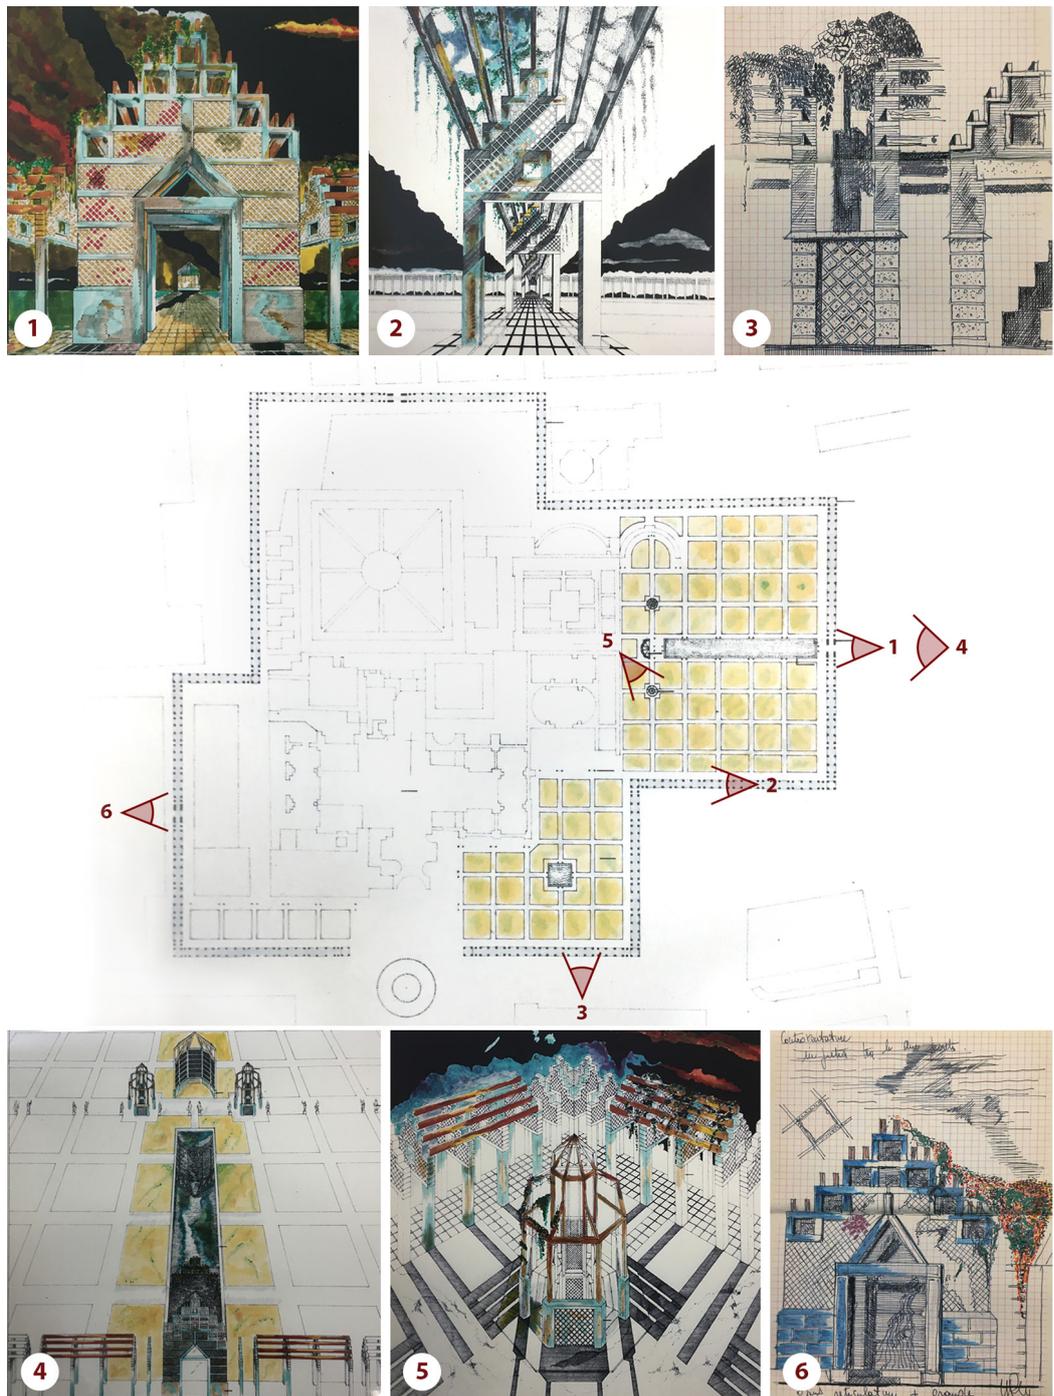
Collocazione dei punti di vista delle prospettive disegnate da Introini sulla planimetria delle terme di Diocleziano. (Disegno degli autori, servizi Bibliotecari e Archivi, Politecnico di Milano, ACL).
